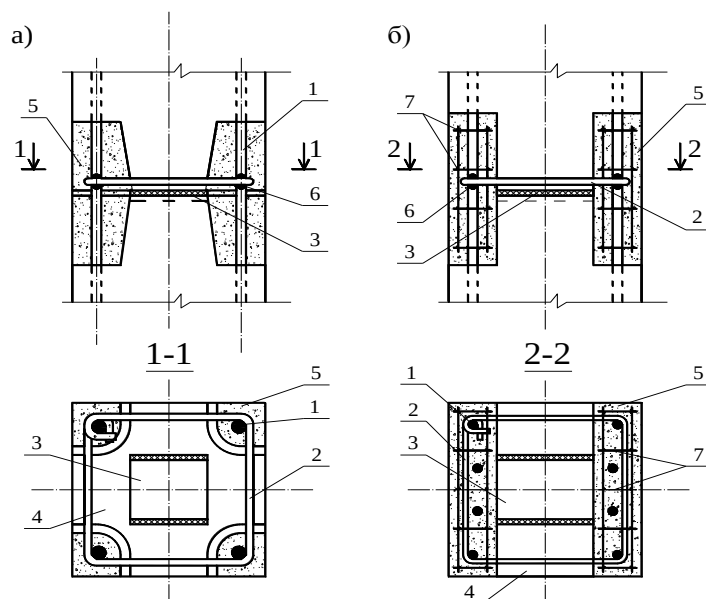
Стык колонн соединением ванной сваркой четырех (а) и восьми (б) арматурных выпусков: 1 – арматурные выпуски; 2 – хомут; 3 – рихтовочная пластина; 4 – зачеканка жестким раствором зазора; 5 – замоноличивание узла бетоном; 6 – ванная сварка арматуры; 7 – сетки
